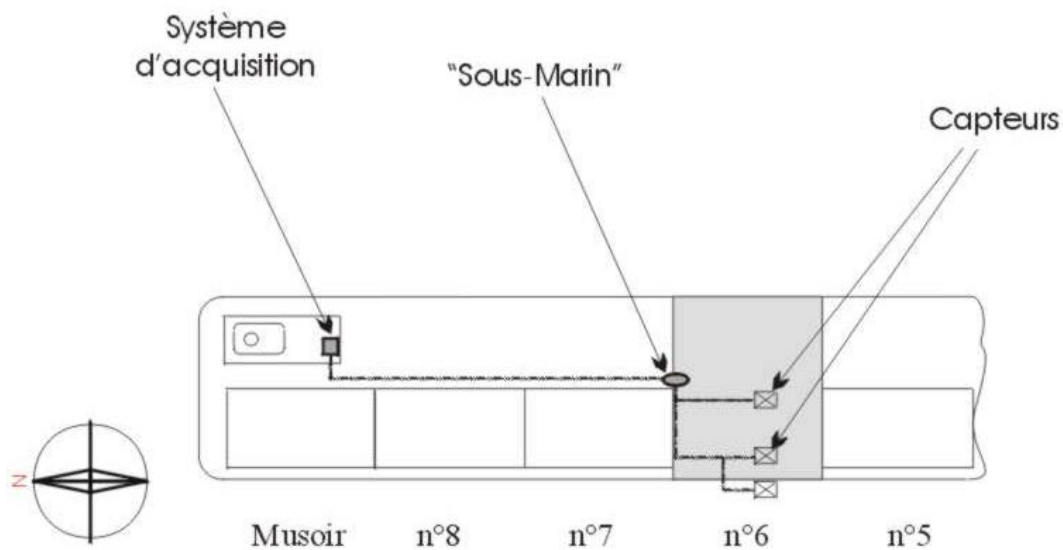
Vue en plan du câblage du caisson n°6.
